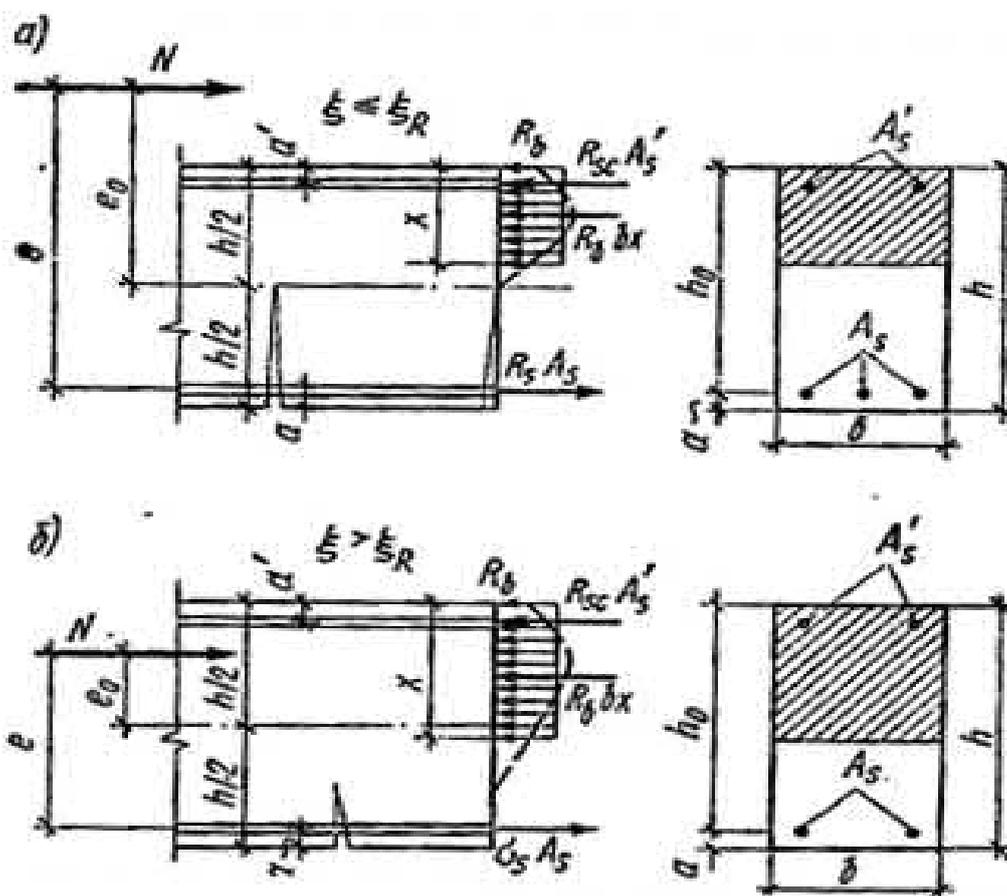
Схемы расчетных усилий в сечениях сжатых железобетонных элементов (а, б)
